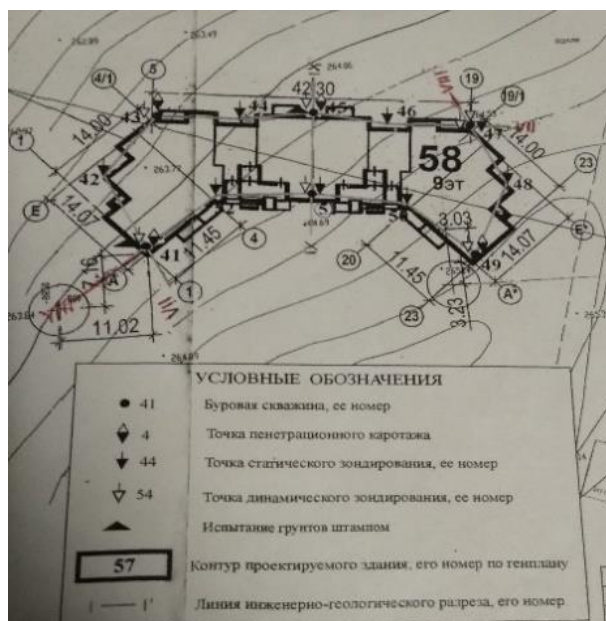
План площадки и точки выполнения статического и динамического зондирования и испытаний эталонных свай
